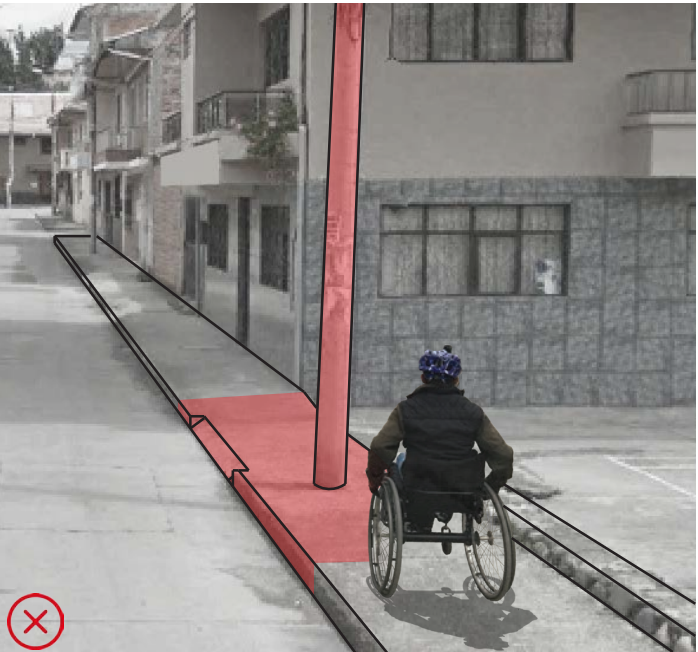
Estado actual. Poste y rampa. Elaboración: Propia.
